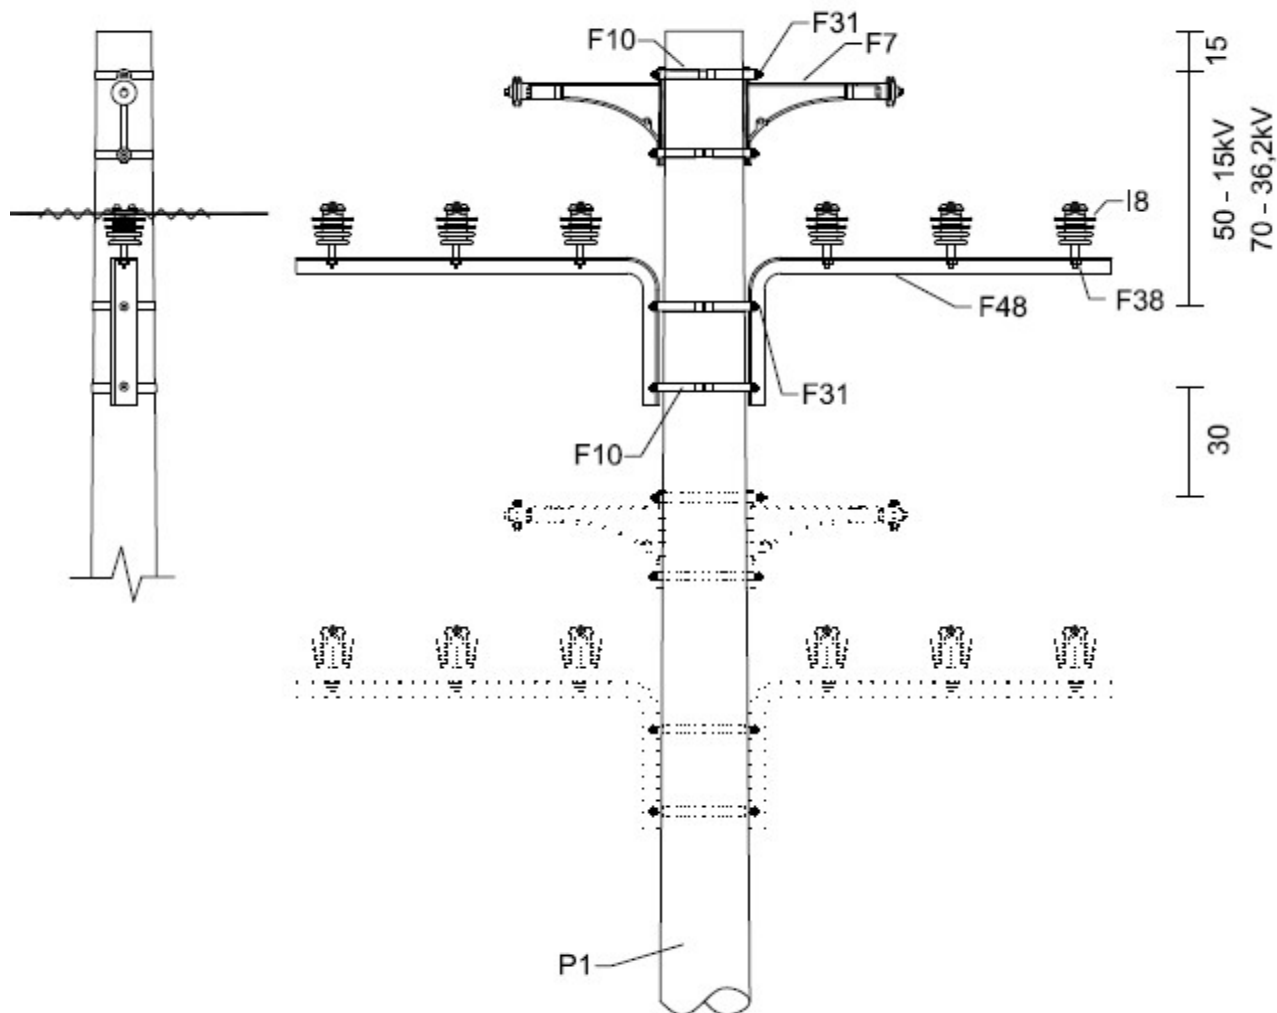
Estrutura CE2H.CE2H com Suporte Horizontal – Poste de Concreto de Seção Circular
